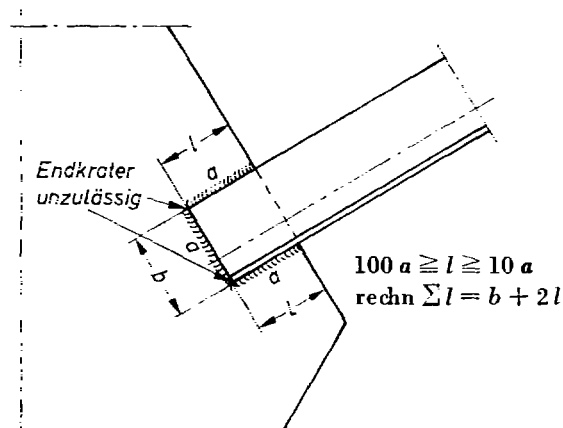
Anschluß mit Stirn- und Flankenkehlnähten
